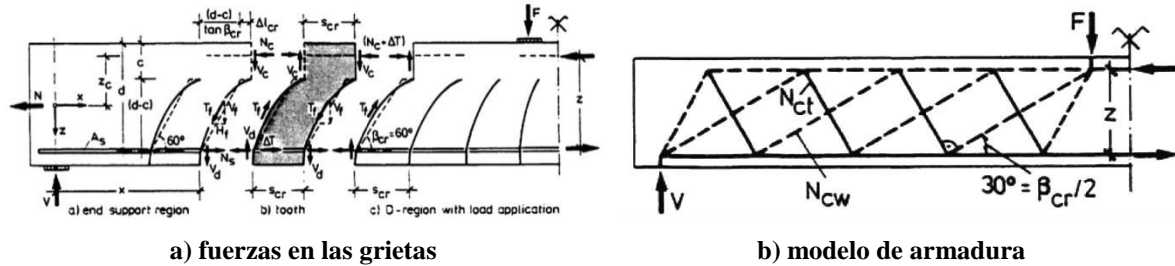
Modelo de armadura con fricción en las grietas propuesto por Reineck (1991)
